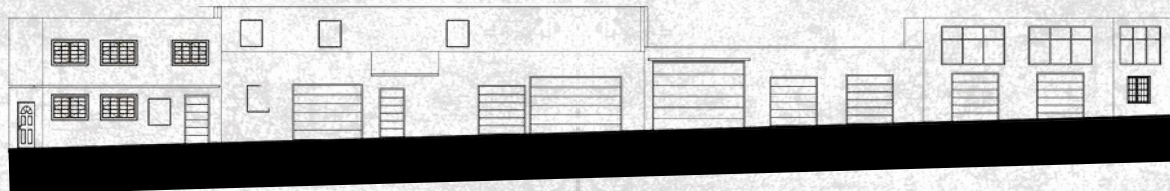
Ubicación y levantamiento técnico de fachada Oeste tramo 1
